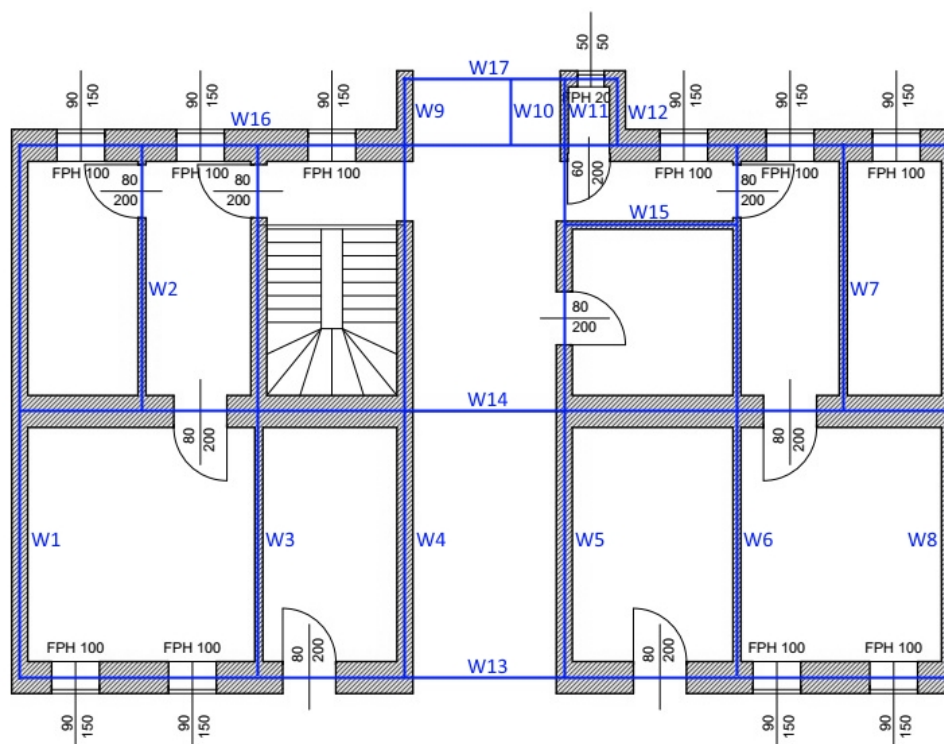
Nummerierung der Wande des symmetrischen Grundrisses
